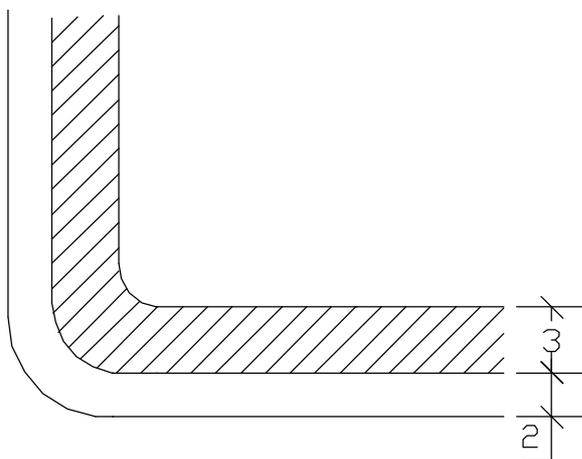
Dimensões de tarja e afastamento para placas laterais à rodovia (em cm)
